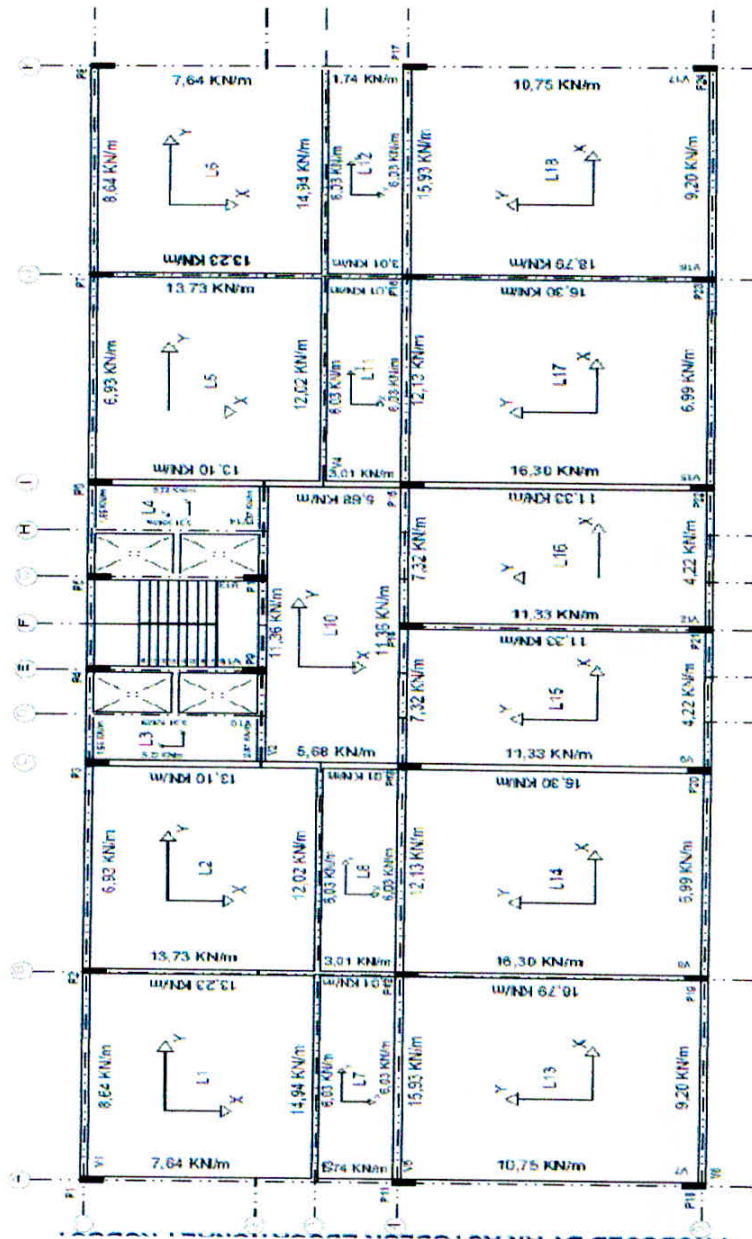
Planta de forma reações das lajes sobre vigas.
